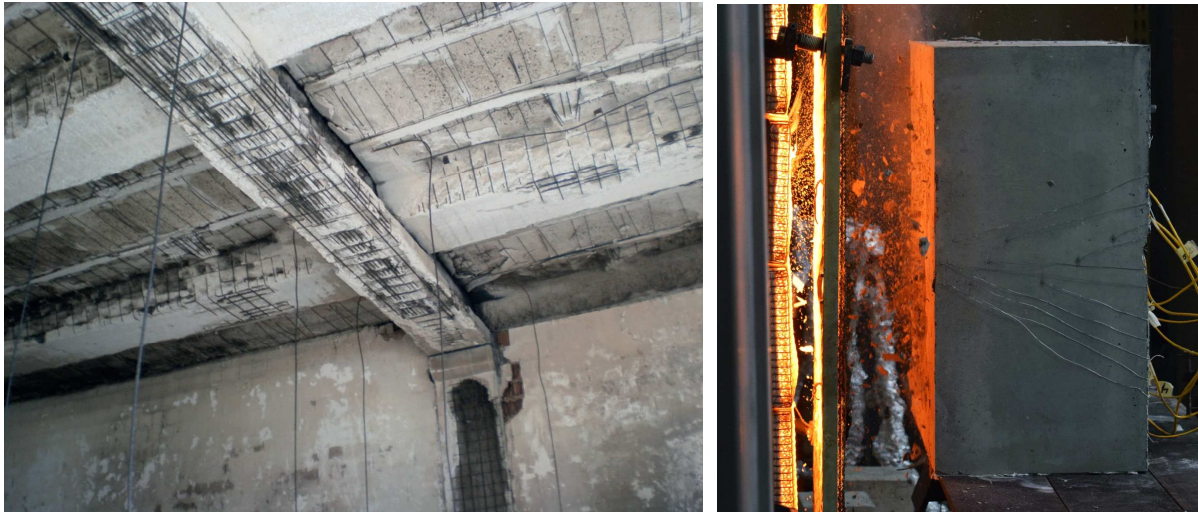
Illustration de l'écaillage au feu de quelques éléments de structure en béton. A gauche, écaillage de poutres, dalles et poteaux suite à un incendie dans un atelier de Cagliari en Italie (2013), selon [122]. A droite, photo prise lors d'un essai de chauffe une face d'un prisme de béton (communication personnelle de Dr Cristian Maluk, Université du Queensland en Australie).
